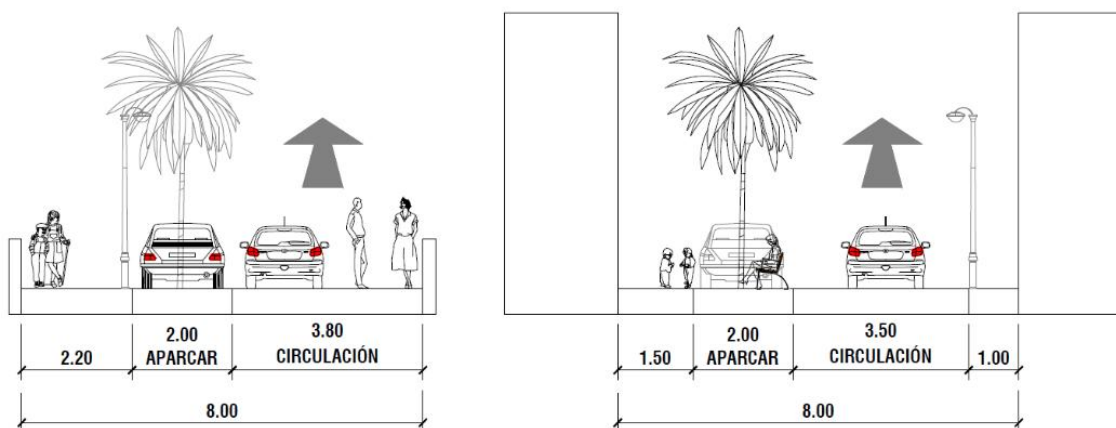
Sección Calle de Convivencia de 8 metros.
